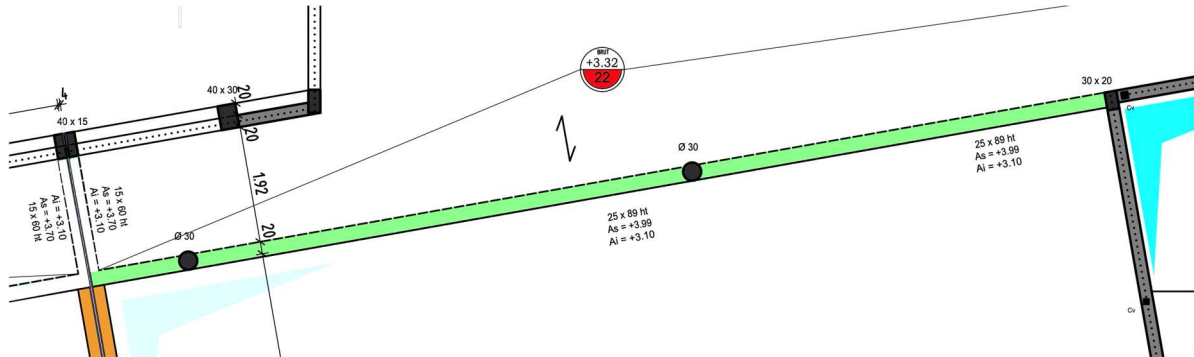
(Extrait document technique DT3) Poutre continue (en vert), plancher haut
